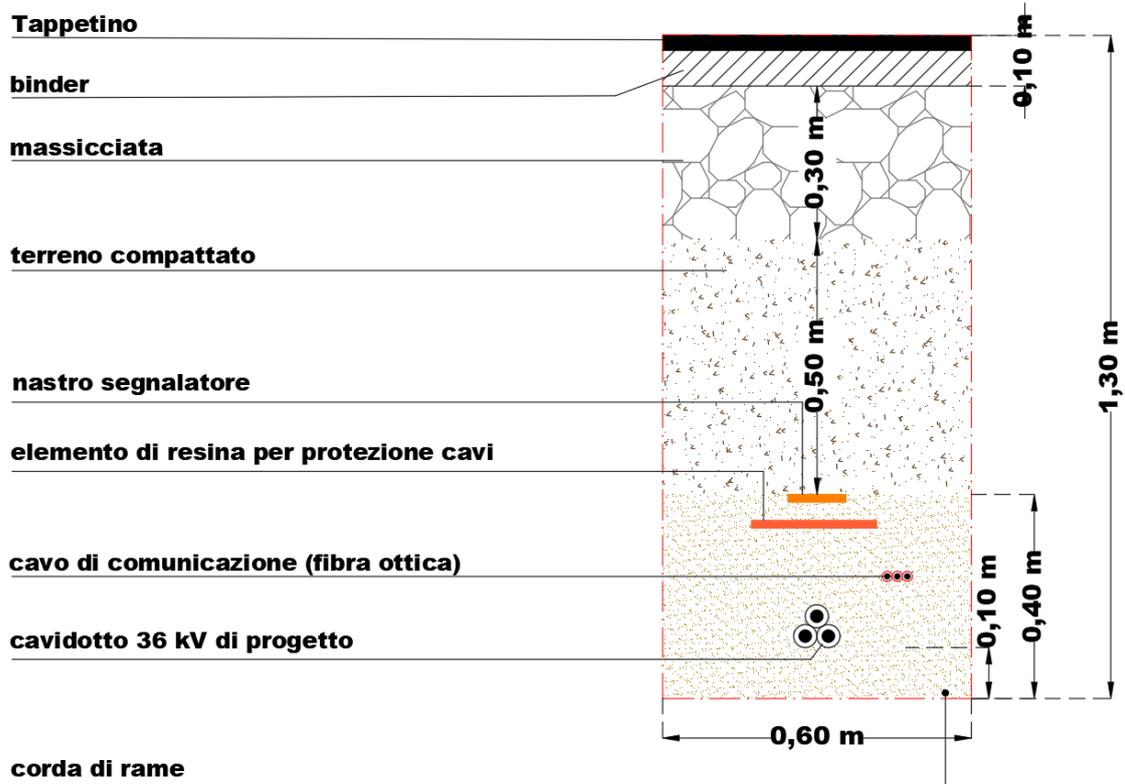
Sezione Cavidotto Singola Terna su Strada Asfaltata
